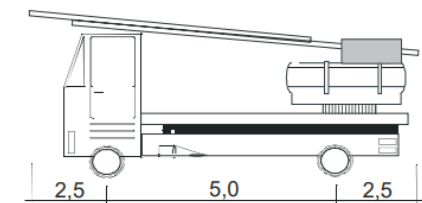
Mått för typfordon Lbn. Källa: Trafikverket.
